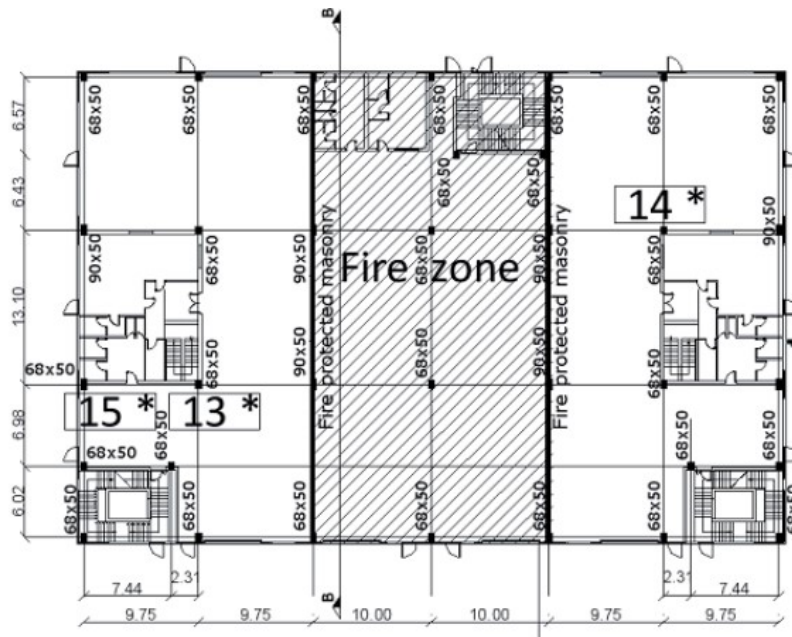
Pianta del Piano Terreno del magazzino industriale esposto al fuoco (Flavio Stochino, Fausto Mistretta, Paola Meloni, Gianfranco Carcangiu (2017), *Integrated Approach for Post-fire Reinforced Concrete Structures Assessment*).
